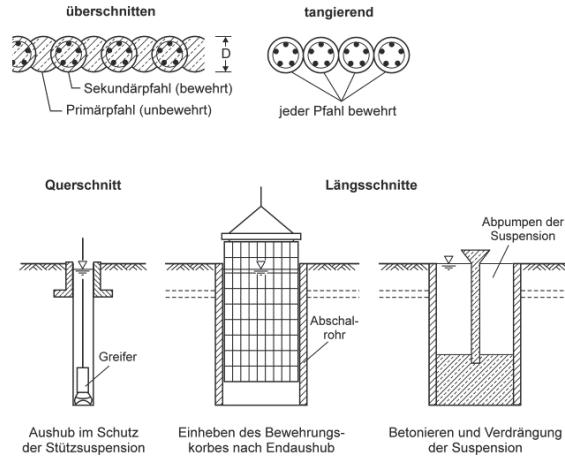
Bohrpfahlwand im Grundriss (oben) und Schlitzwand (unten)
